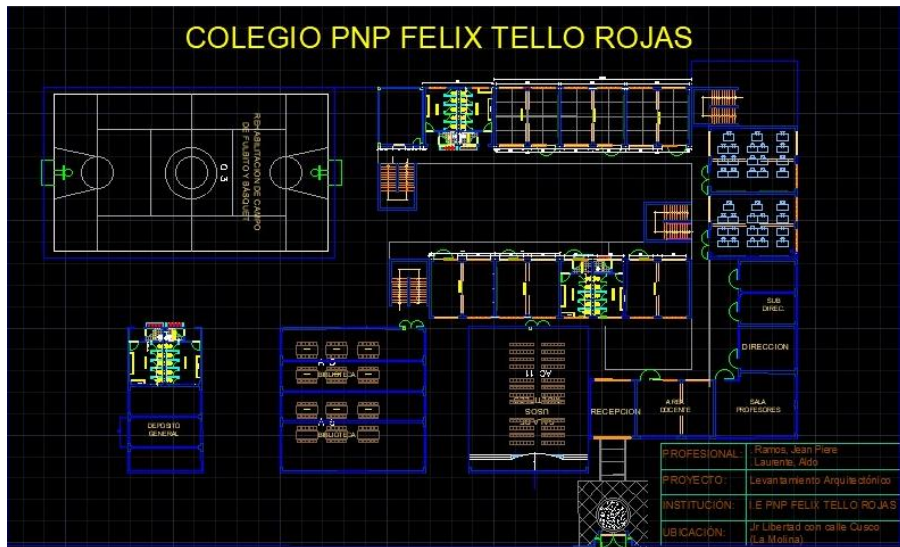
Plano de planta de PNP Félix Román Tello Rojas
